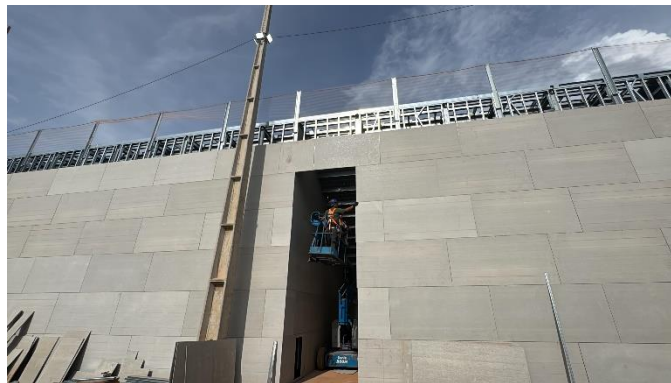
Instalação de placas cimentícias na estrutura. (Fonte: Próprio autor).
